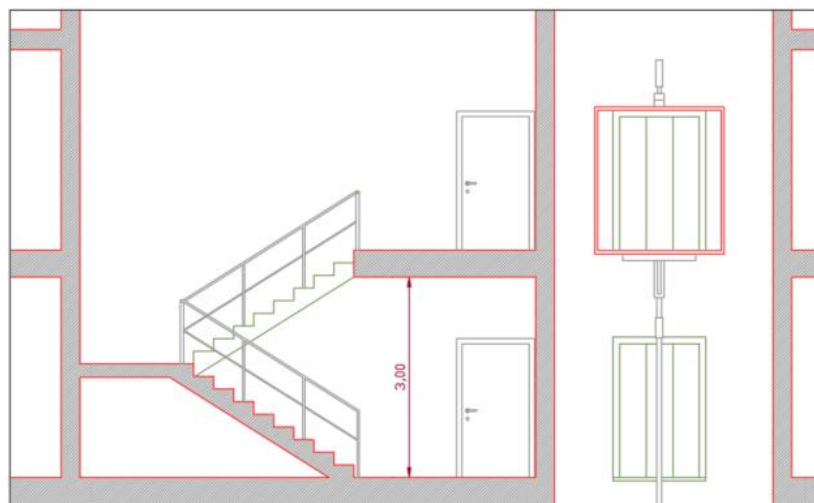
Solução da escada de betão armado nos cortes de arquitetura.
